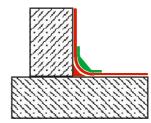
Дополнительная гидроизоляция пристенного клина Hygrostop-Эластичным Армированным в случае, когда проект/выполнение допускает взаимное перемещение стены и плиты.
